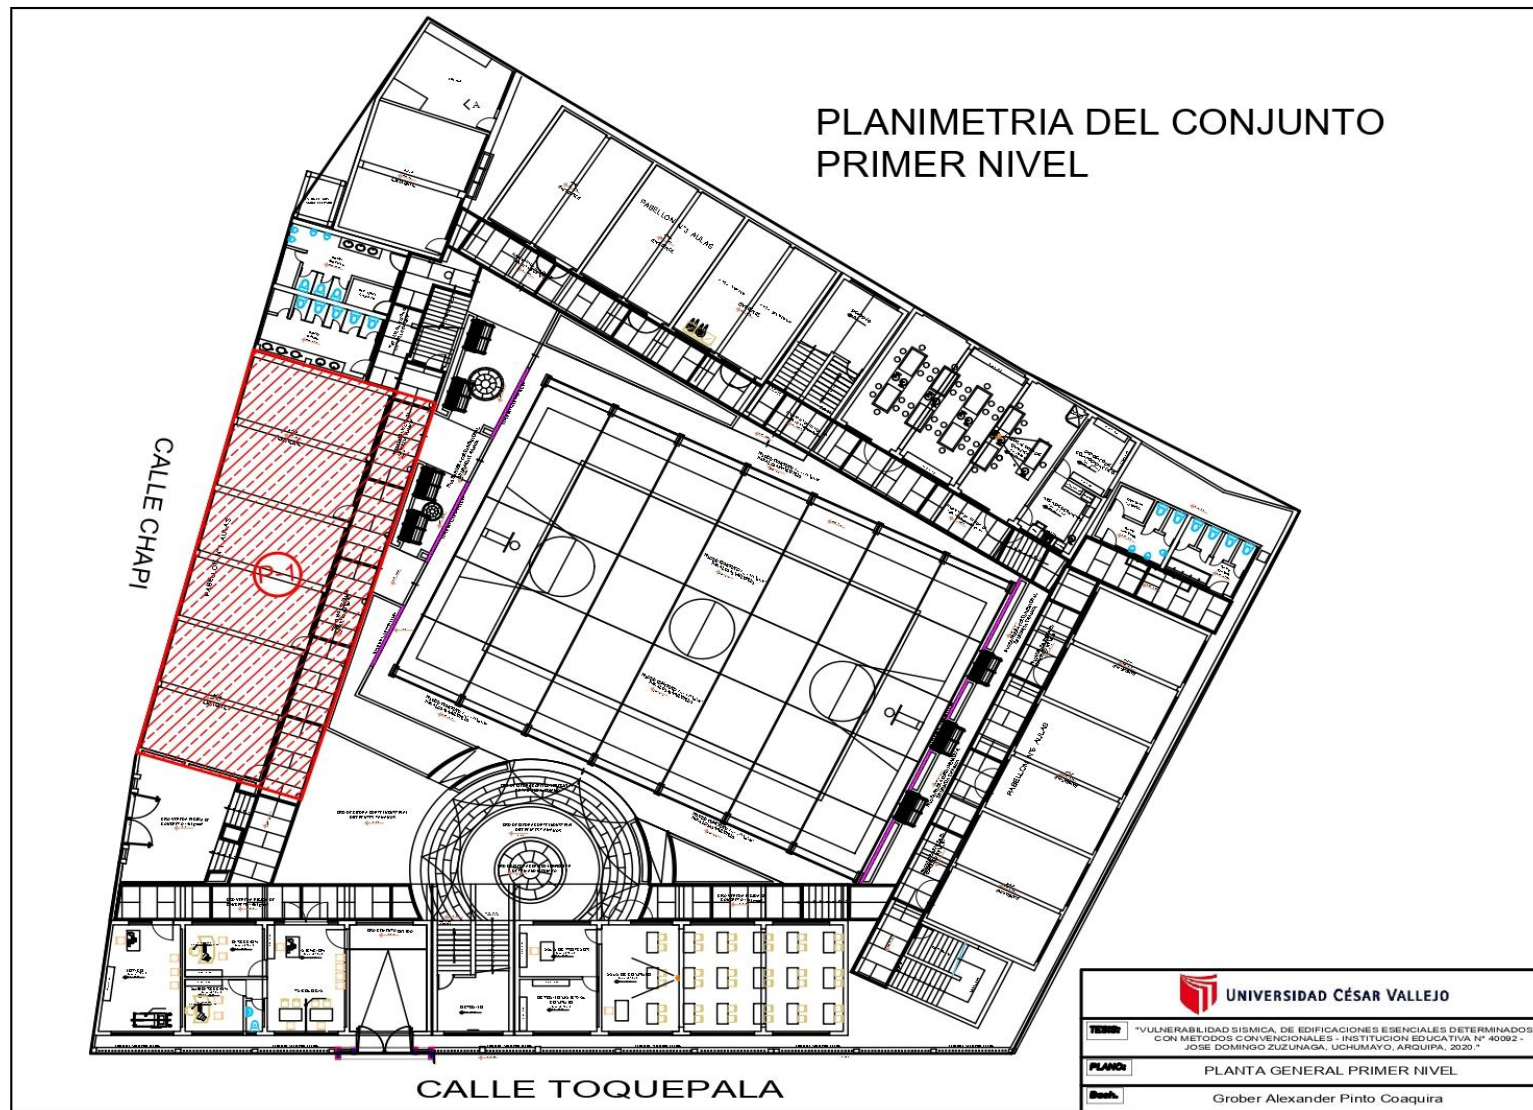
Plano general de la Institución Educativa existente con el pabellón a intervenir P-1
